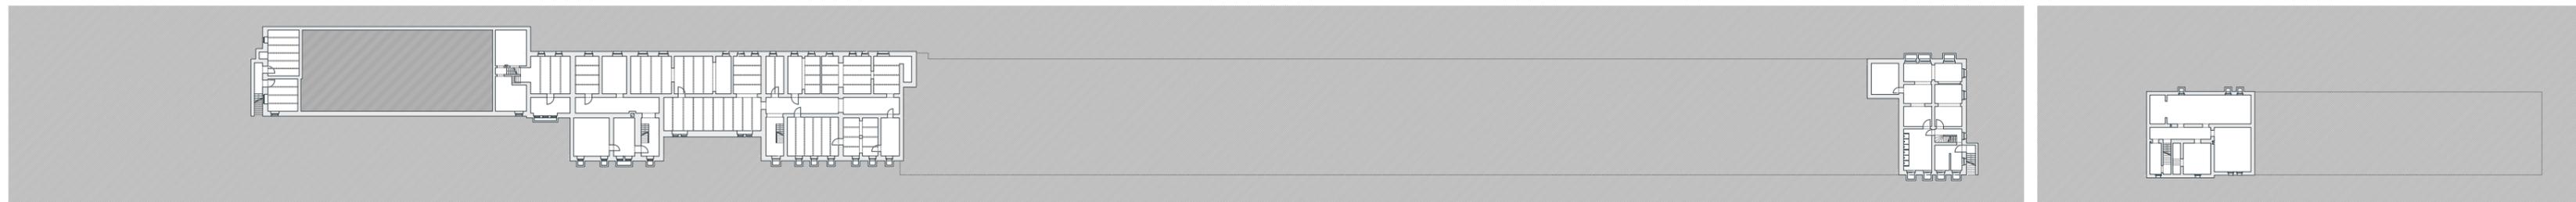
Grundriss des Kellergeschosses der Gesamtanlage, 1904 o.M.
